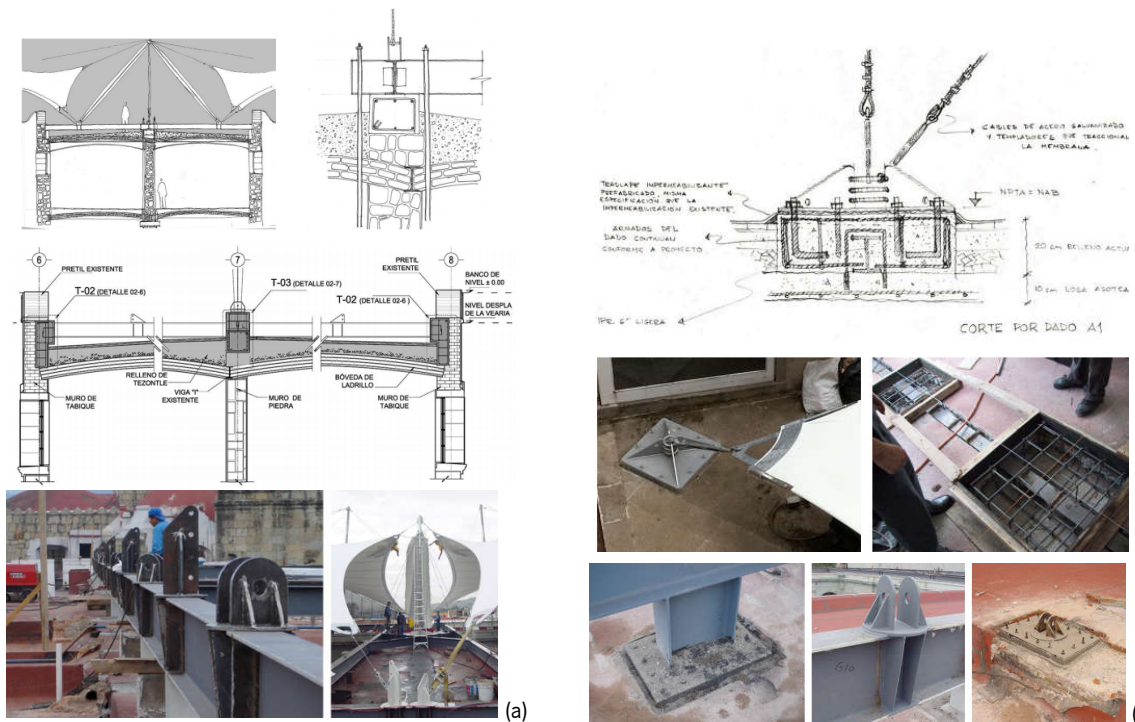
Pormenores de ancoragem: (a) no “Hospital Feminino” (México); (b) de mastros e cabos da estrutura de membrana sobre a laje de betão armado do “Palácio de Minería” (México).
